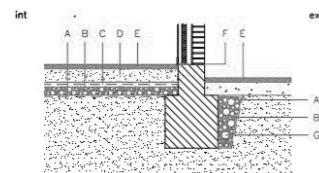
Elementos del encuentro del suelo con el muro según CTE
